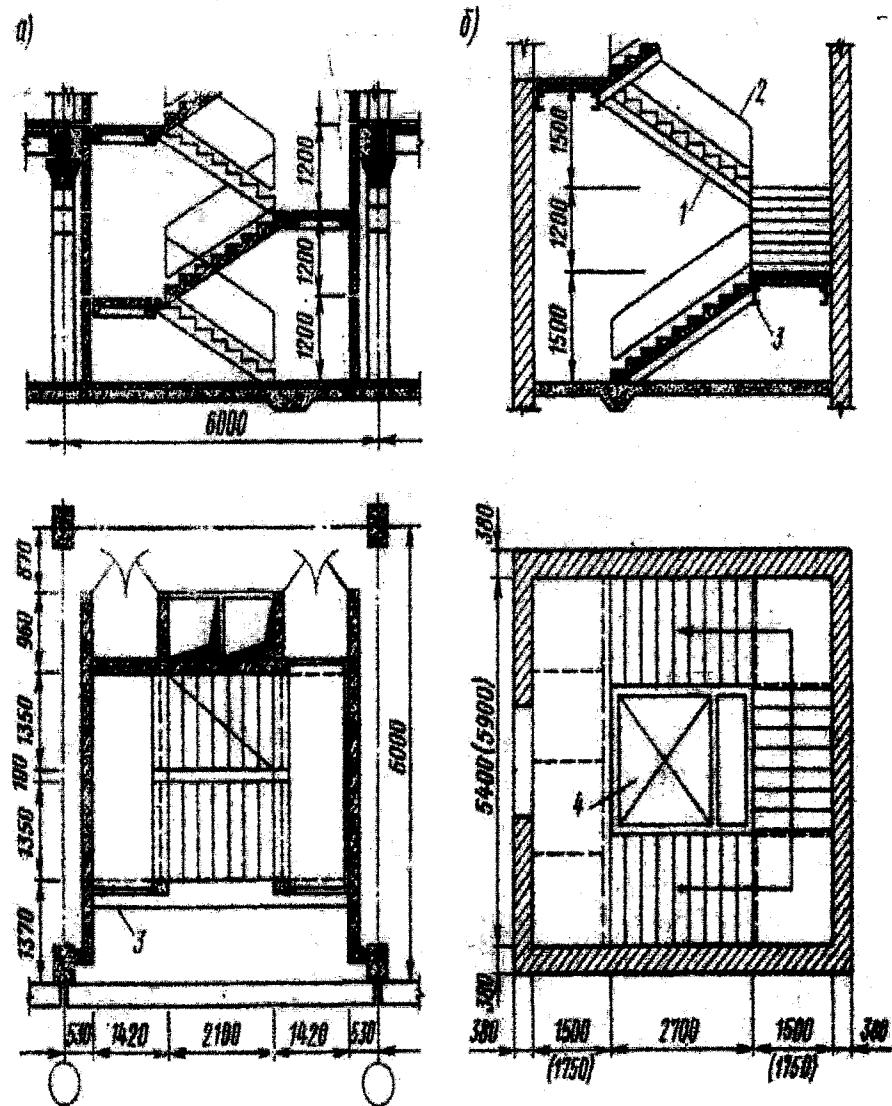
Основні сходи багатоповерхових будівель:
